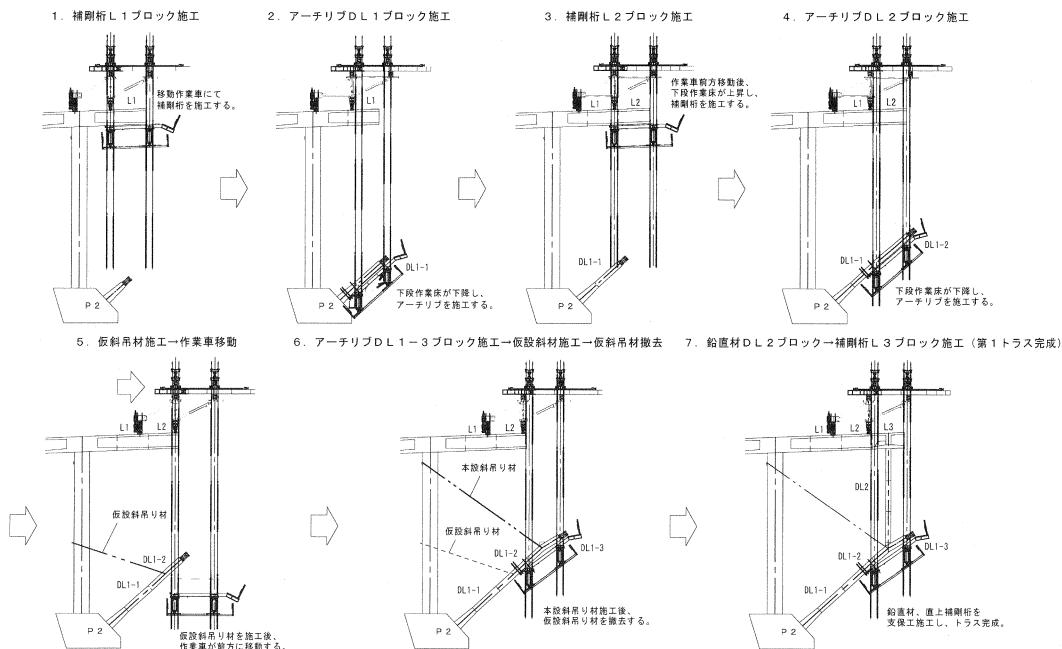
第1トラス形成までの施工ステップ（アーチリブ分割施工）
